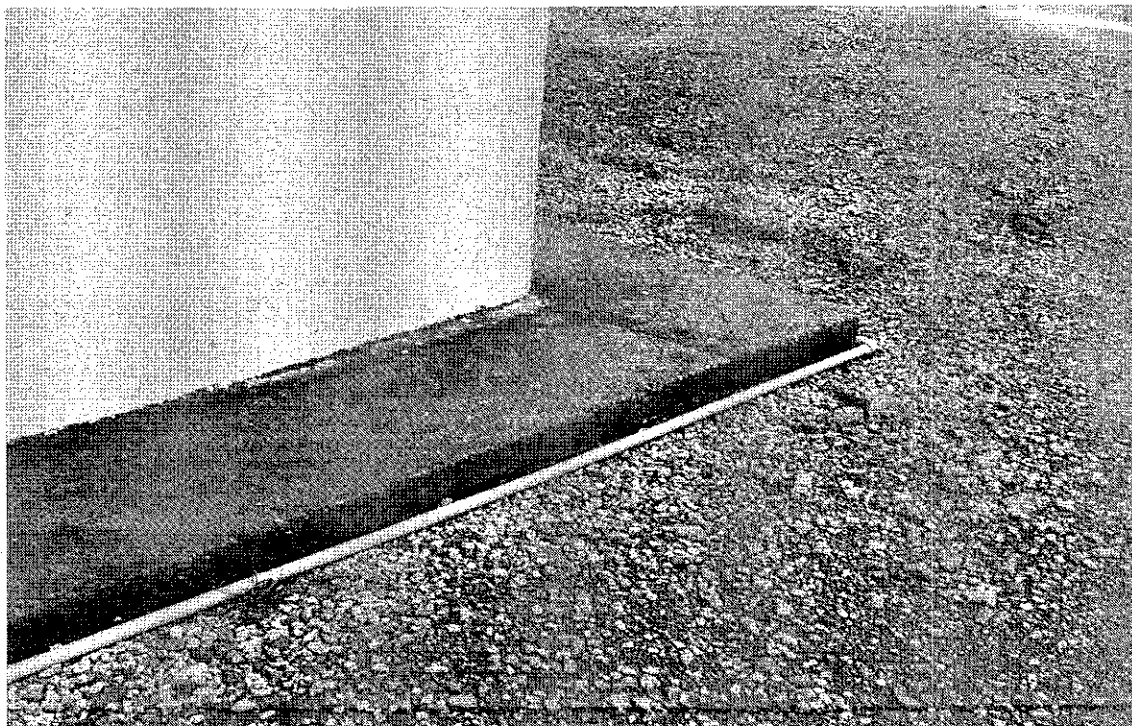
Encanamento instalada na parte externa da casa – lote 37
